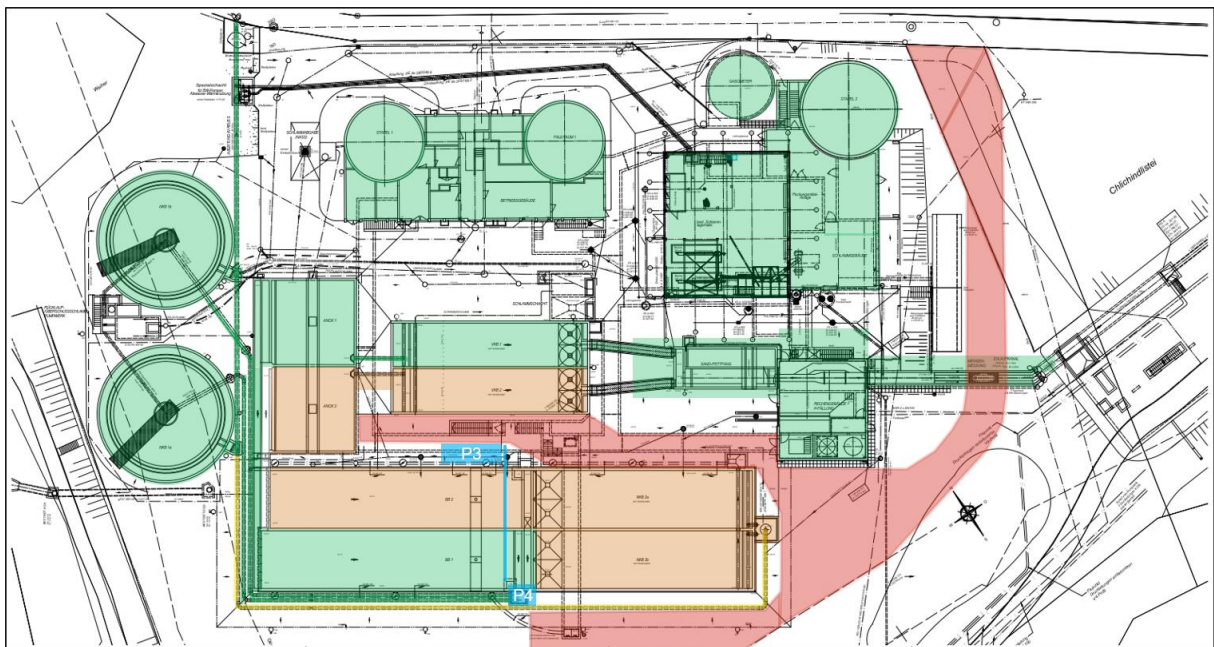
Etappe 2.1 Sanierung Strasse 2 und Neubau MBR
